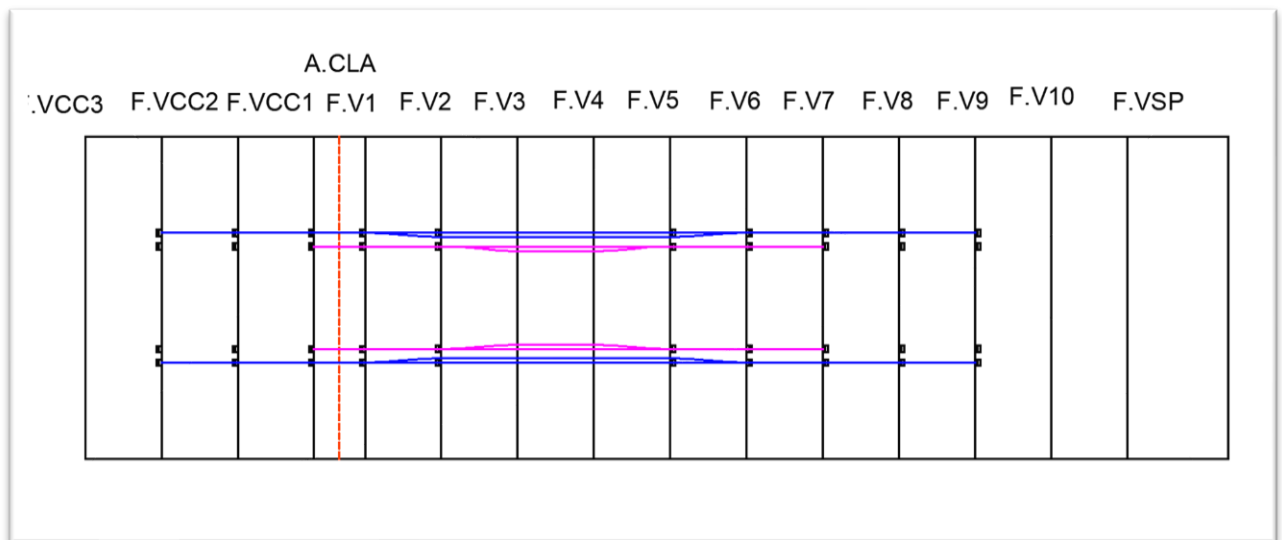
Schéma se trace en plan de câbles de continuités de travée de rive gauche
